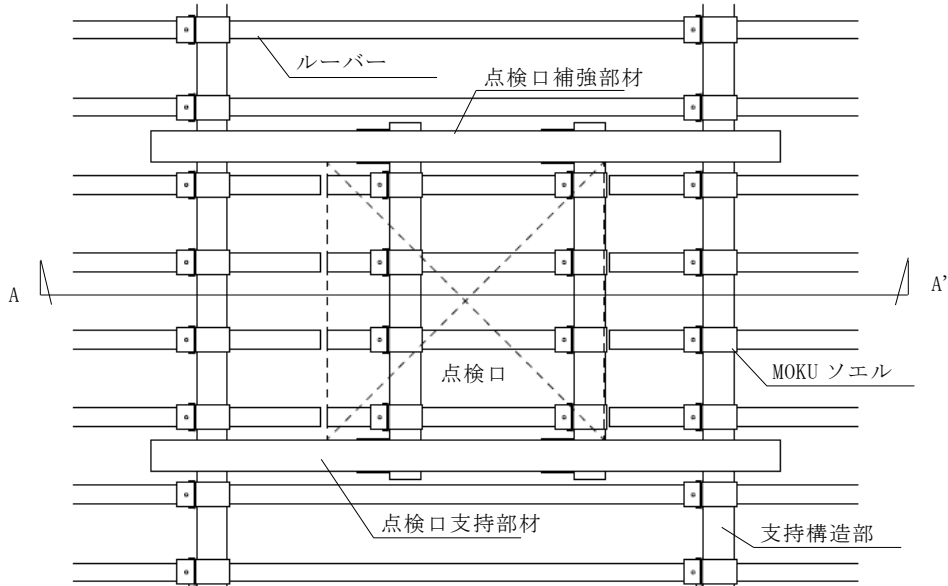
点検口補強部材および MOKU ソエル設置 平面図
